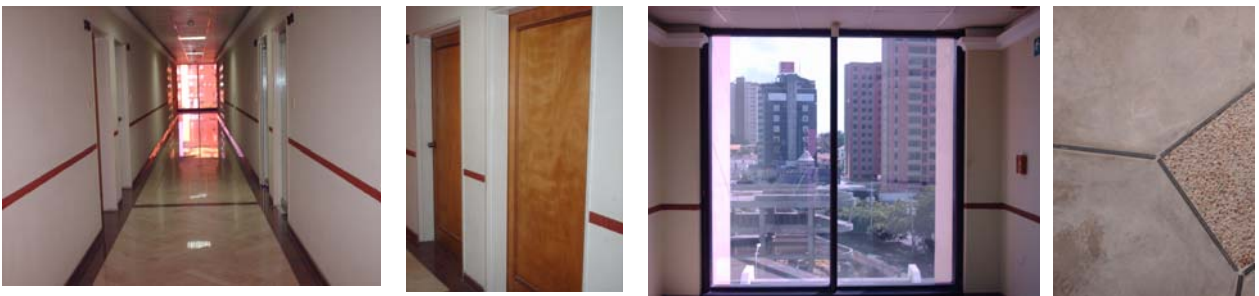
Fotos pavimento de porcelanato, puertas, ventana y baldosas de piso.
